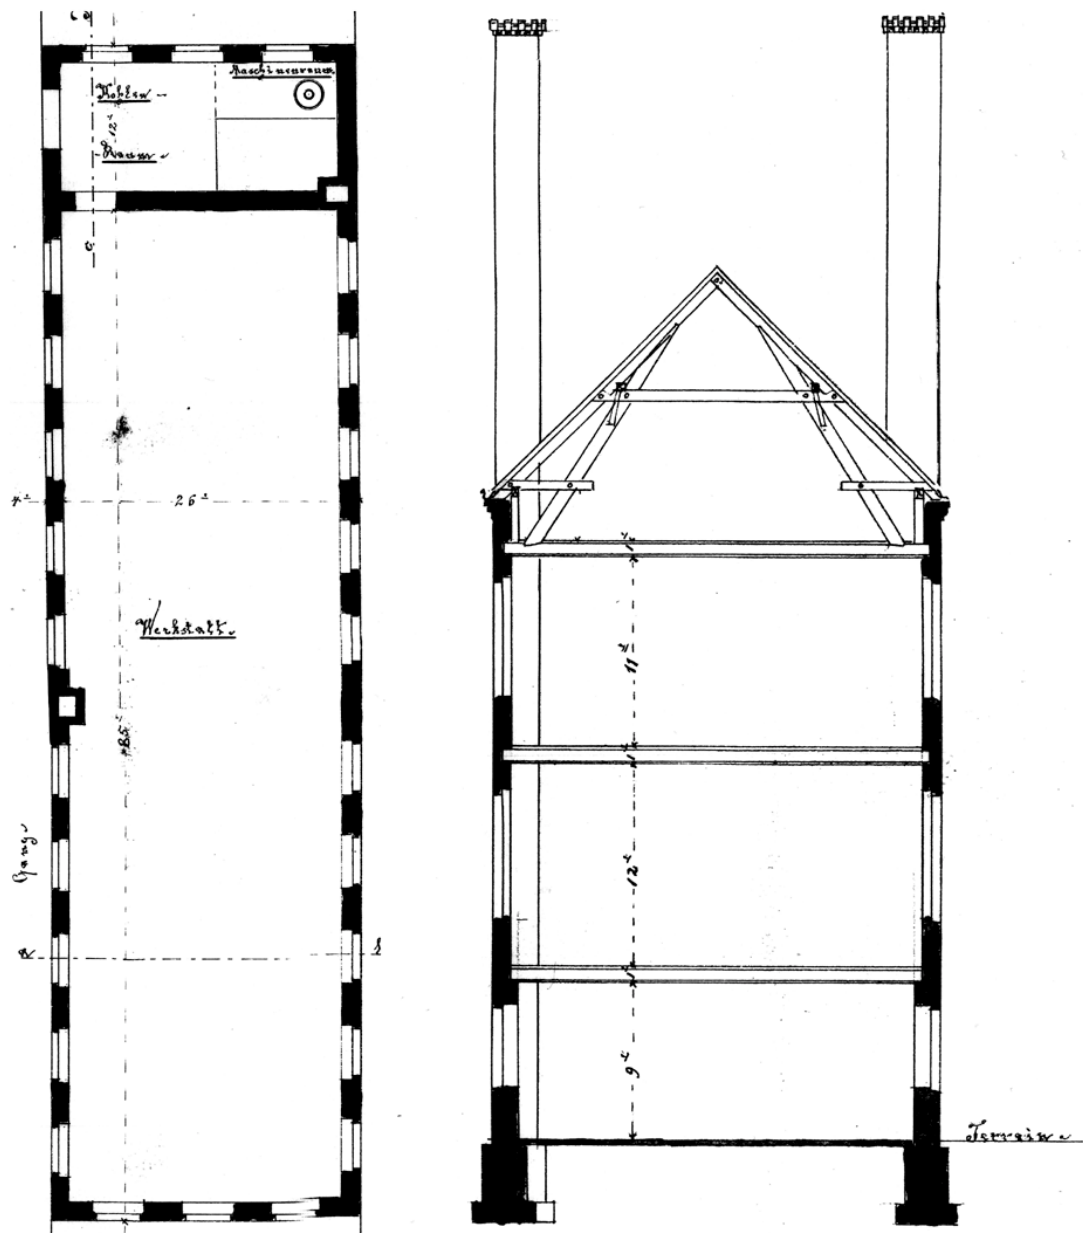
Links: Grundriß des Fabrikgebäudes, verkleinert; Werkstatt, Kohlenraum, Dampfmaschinenraum mit Kessel. Rechts: Höhenschnitt durch den unteren Maschinenraum und die oberen Werkstatträume.
